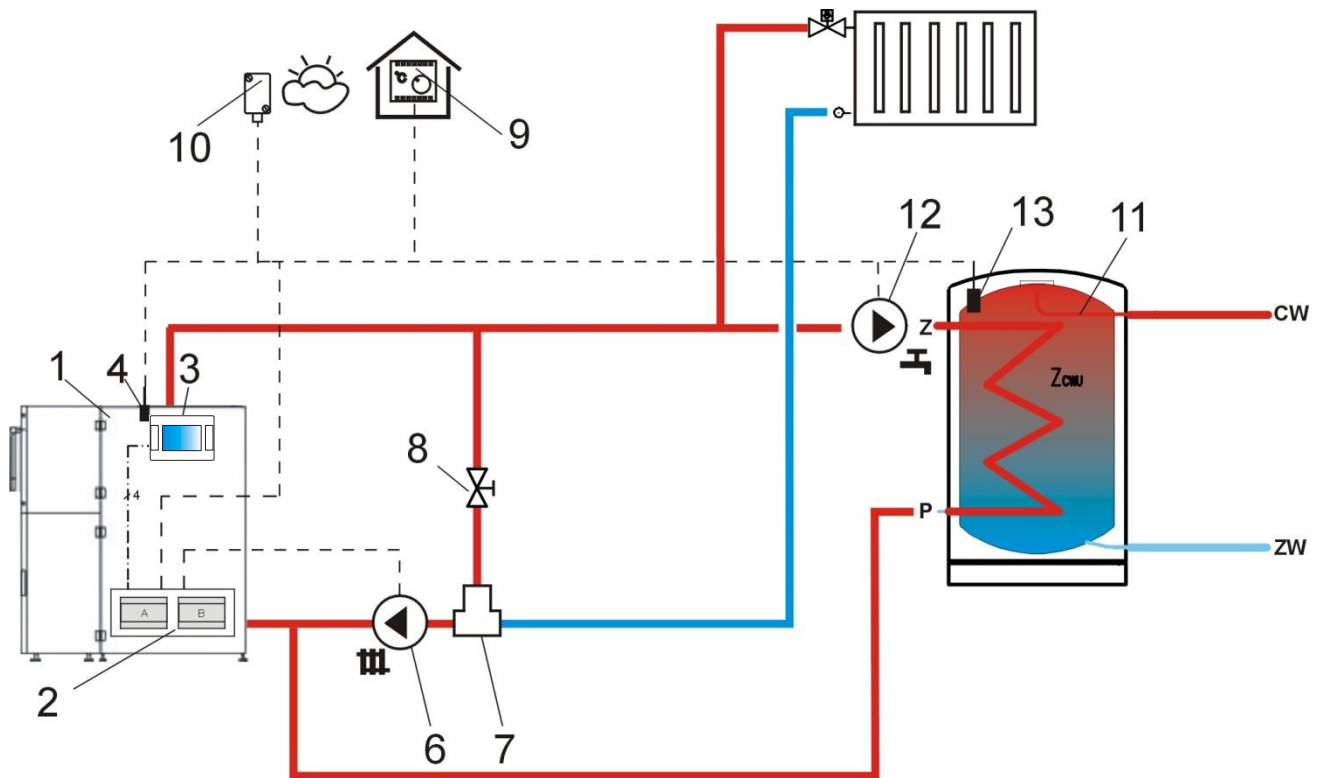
Schema mit thermostatischem 3-Wegeventil zum Schutz der Temperatur des Rücklaufwassers⁵: 1 – Kessel mit Beschicker, 2 – Regler ecoMAX810P-L (Ausführungsmodul), 3 – Steuerpanel des Reglers, 4 – Temperatursensor (Kessel), 6 – ZH-Pumpe, 7 – thermostatisches 3-Wegeventil, 8 – Drosselventil (Tellerventil), 9 – Zimmerthermostat, 10 – Wettersensor, 11 – BW-Behälter, 12 – BW-Pumpe, 13 – BW-Temperatursensor.
